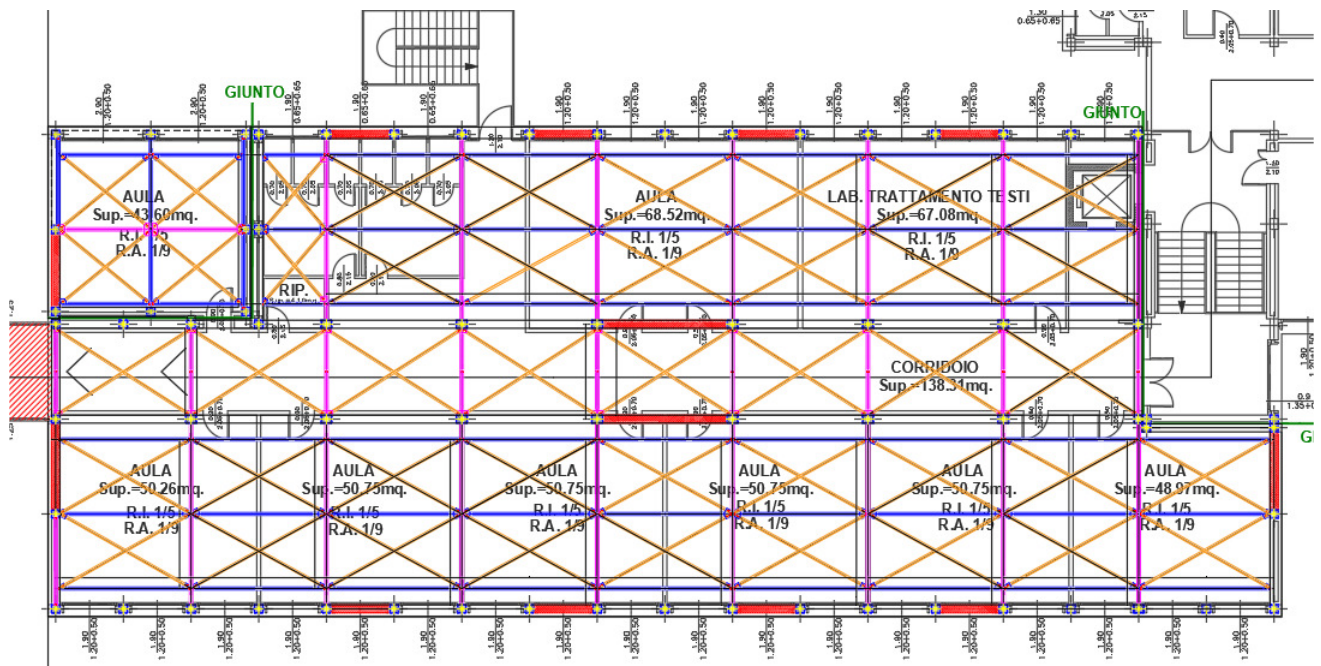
Lavori strutturali LOTTO 2 – piano secondo
